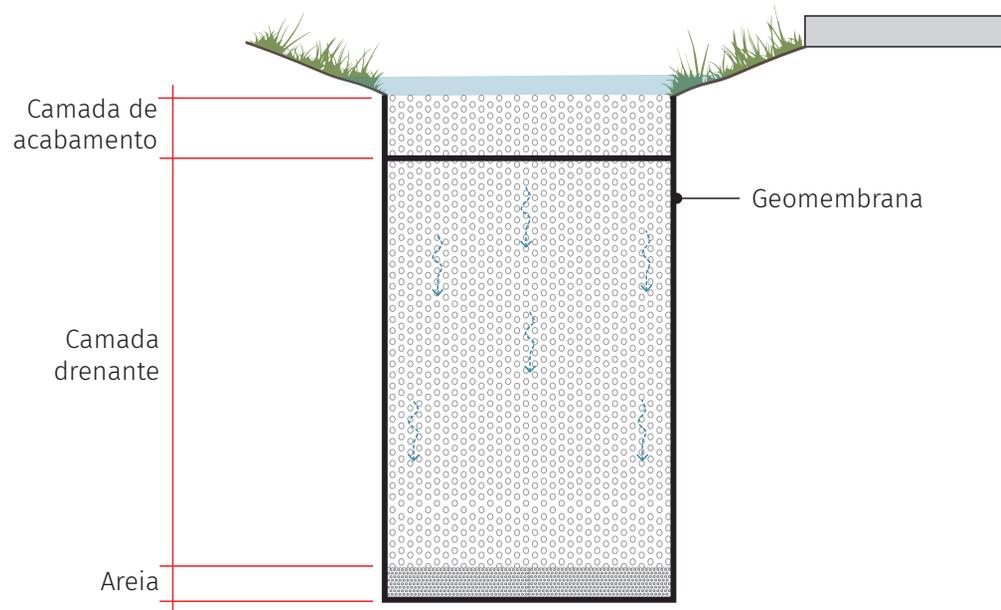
Corte esquemático de facilitador de infiltração do tipo trincheira (FCTH, 2024)
